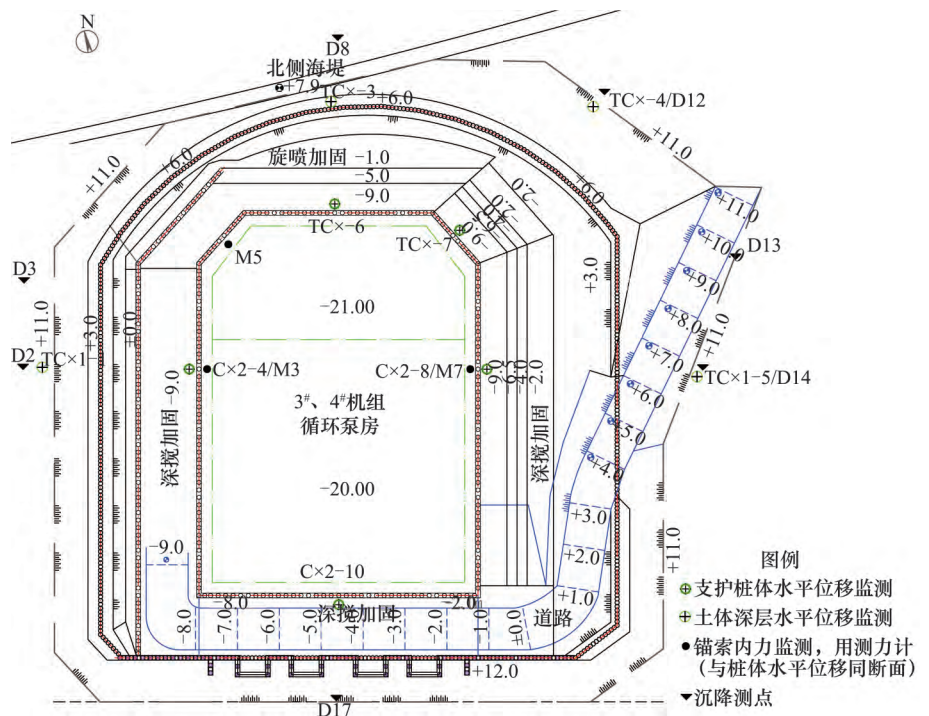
二期泵房深基坑开敞式支护平面布置(单位: m)
